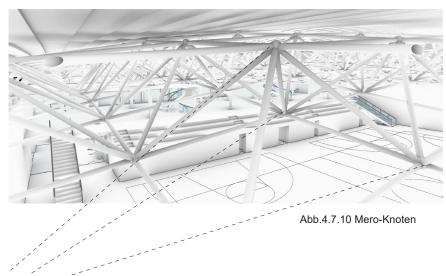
Konstruktionsvarianten-Sporthalle-Dachvariante
